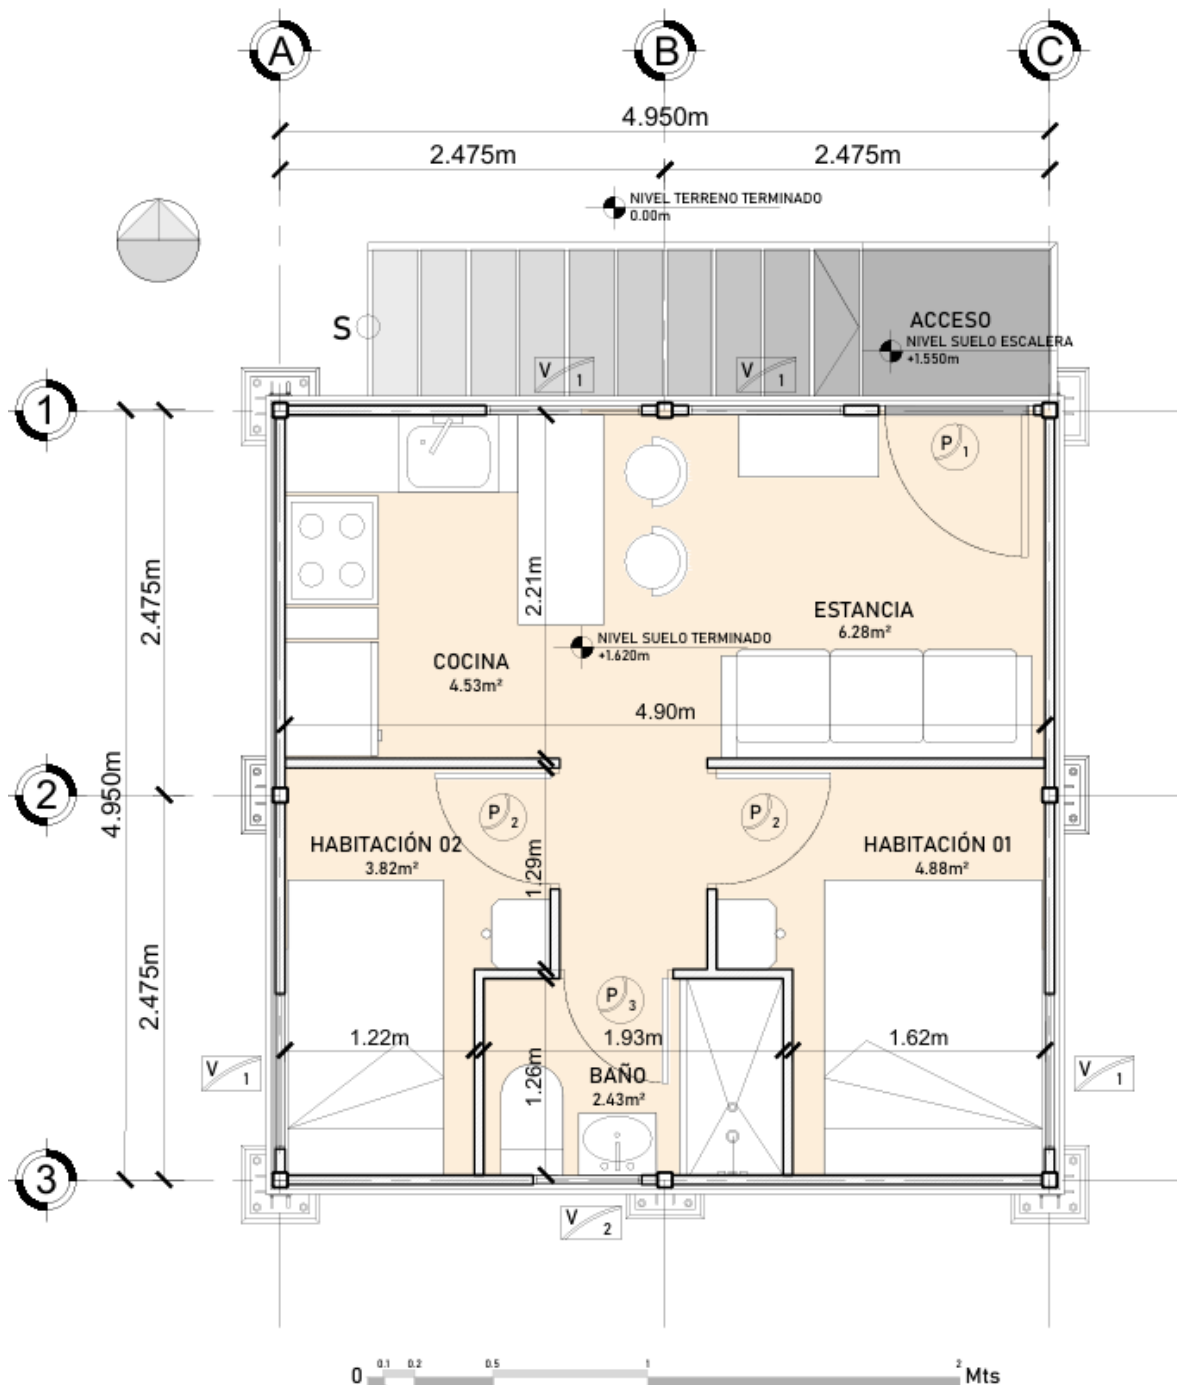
Módulo (Propuesta de Posible Planta de Distribución). Fuente: Elaboración propia
